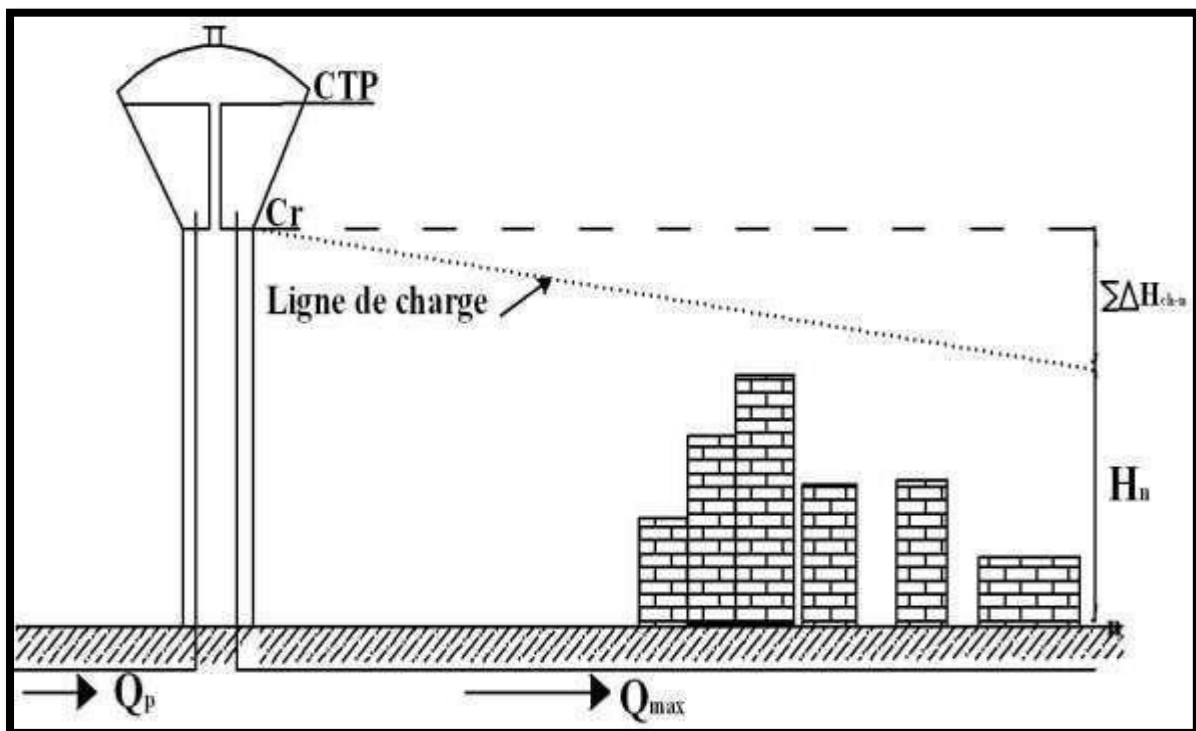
la hauteur du château d'eau par apport bâtiment.
